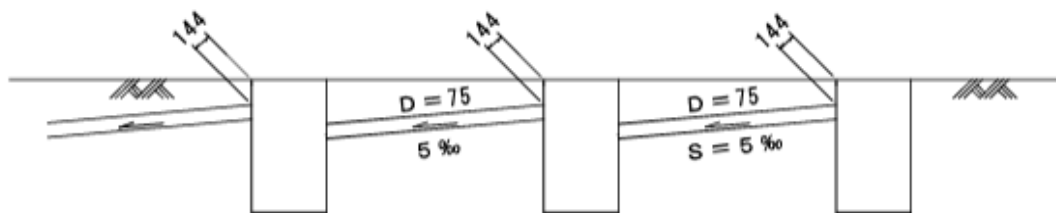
主管施工断面図 (B型浸透ますの場合)
